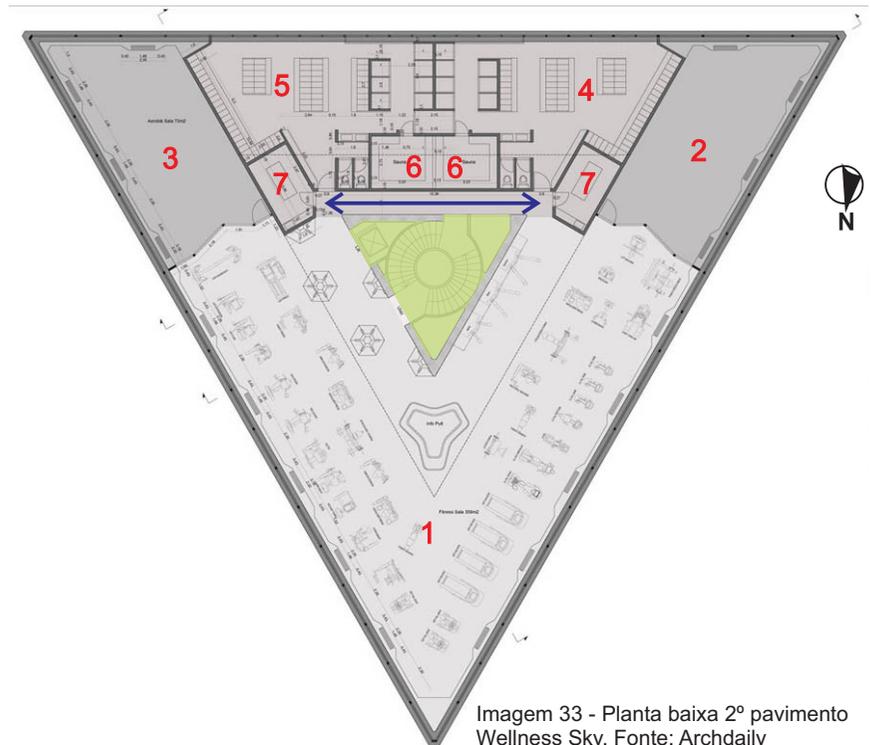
Planta baixa 2º pavimento Wellness Sky. Fonte: Archdaily
